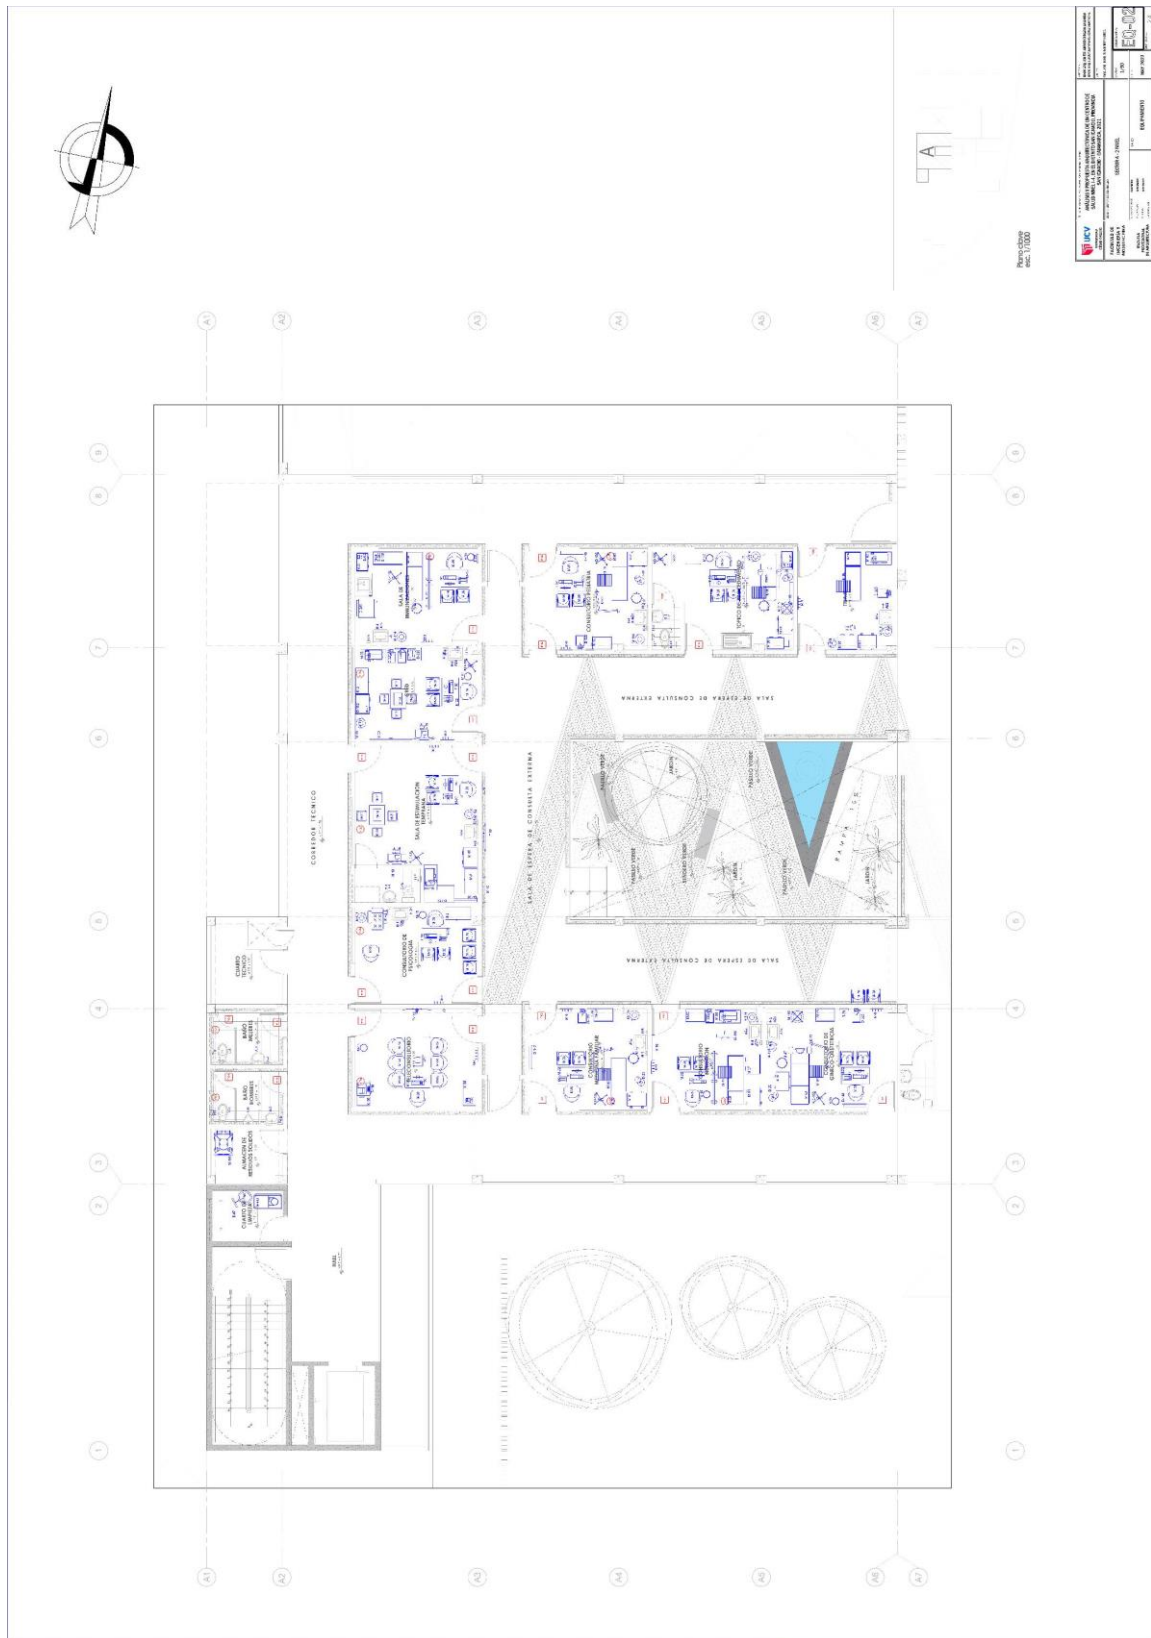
Plano de equipamiento de tercer nivel – SECTOR A
